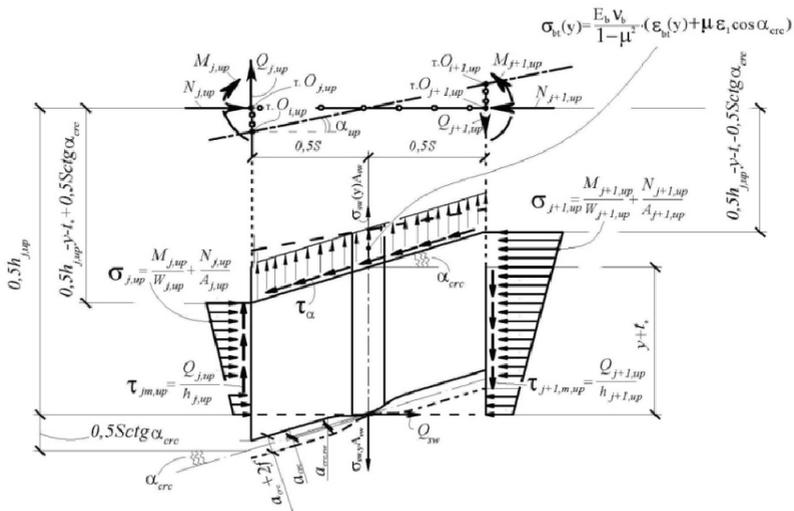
Расчетная схема к определению деформаций растяжения бетона по наклонным сечениям в железобетонной конструкции
